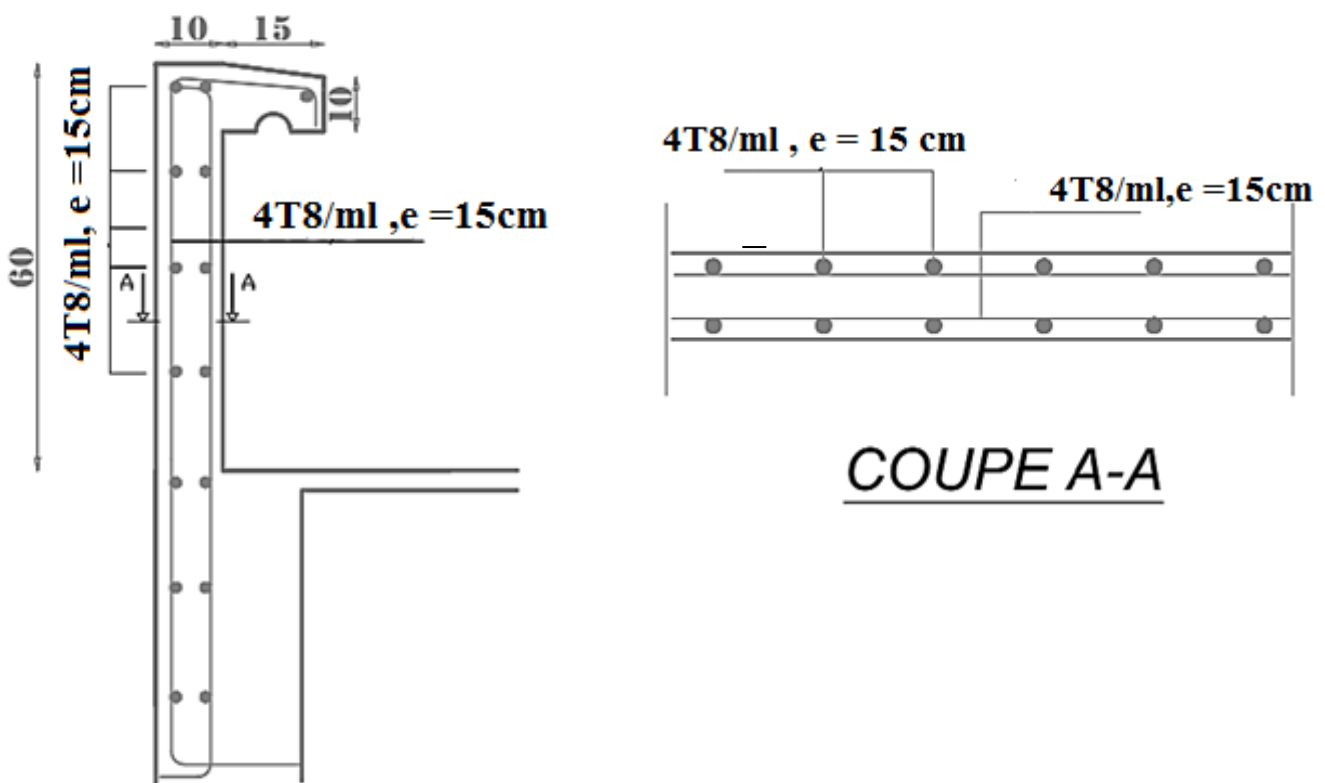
Schéma de ferrailage de l'acrotère et la coupe A-A.
